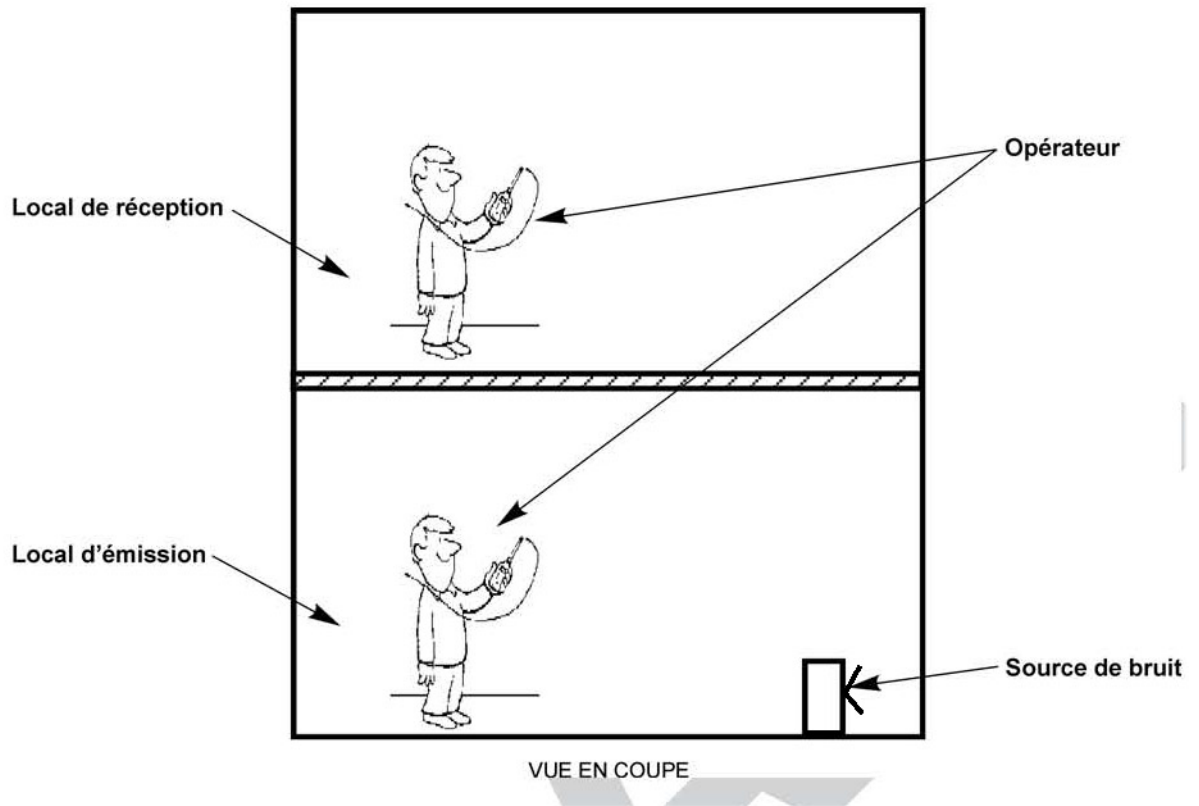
Mesurage de l'isolement vertical entre locaux.
